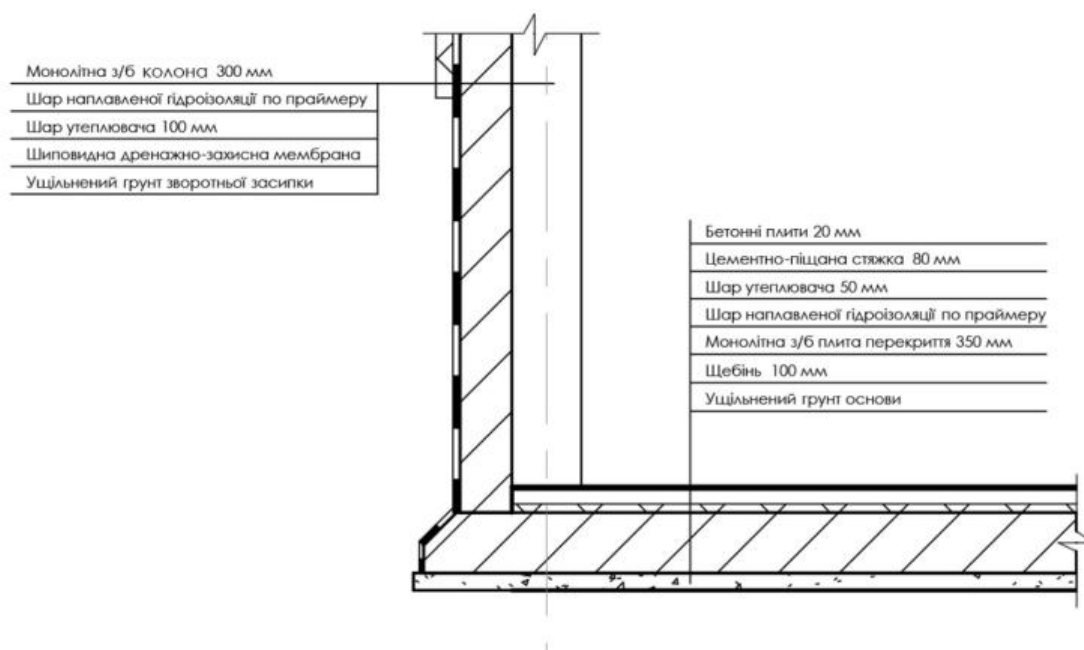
Конструктивне рішення фундаменту будівлі
